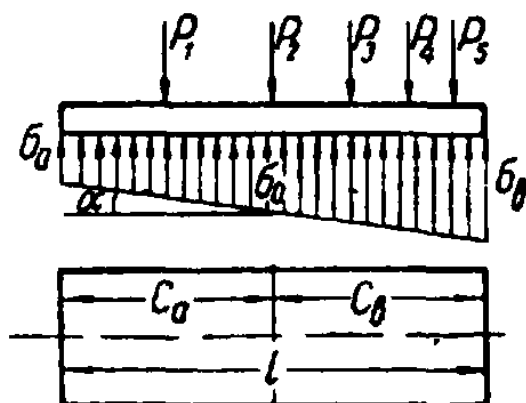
Эпюра напряжений для абсолютно жесткой балки.
